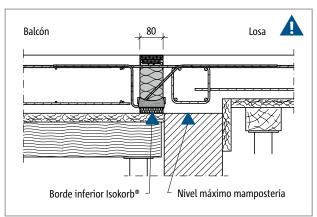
Schöck Isokorb® T tipo K: Balcón de hormigón in situ con losa desplazada en altura sobre muro de mampostería
